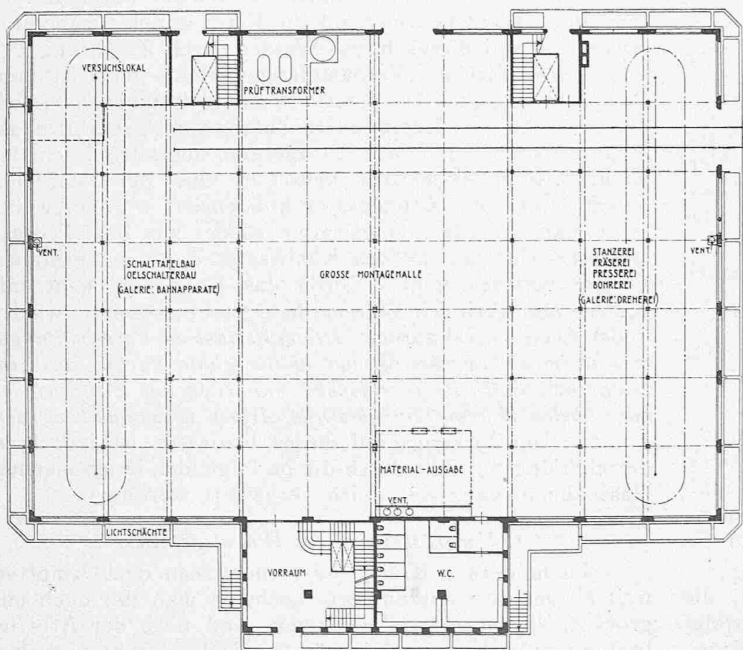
Montage-Halle im Erdgeschoss; links die Galerie für Bahnapparatebau.
